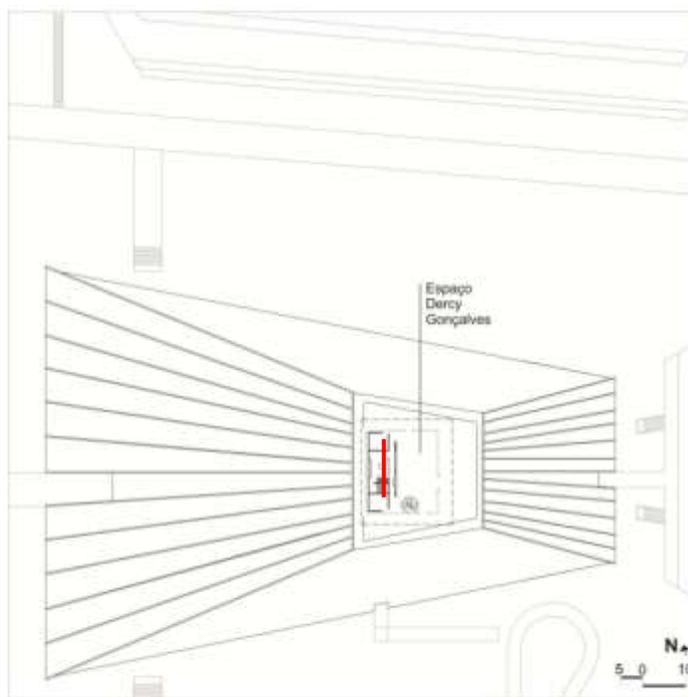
Planta Baixa - 4º Pavimento (+21,63 m).
